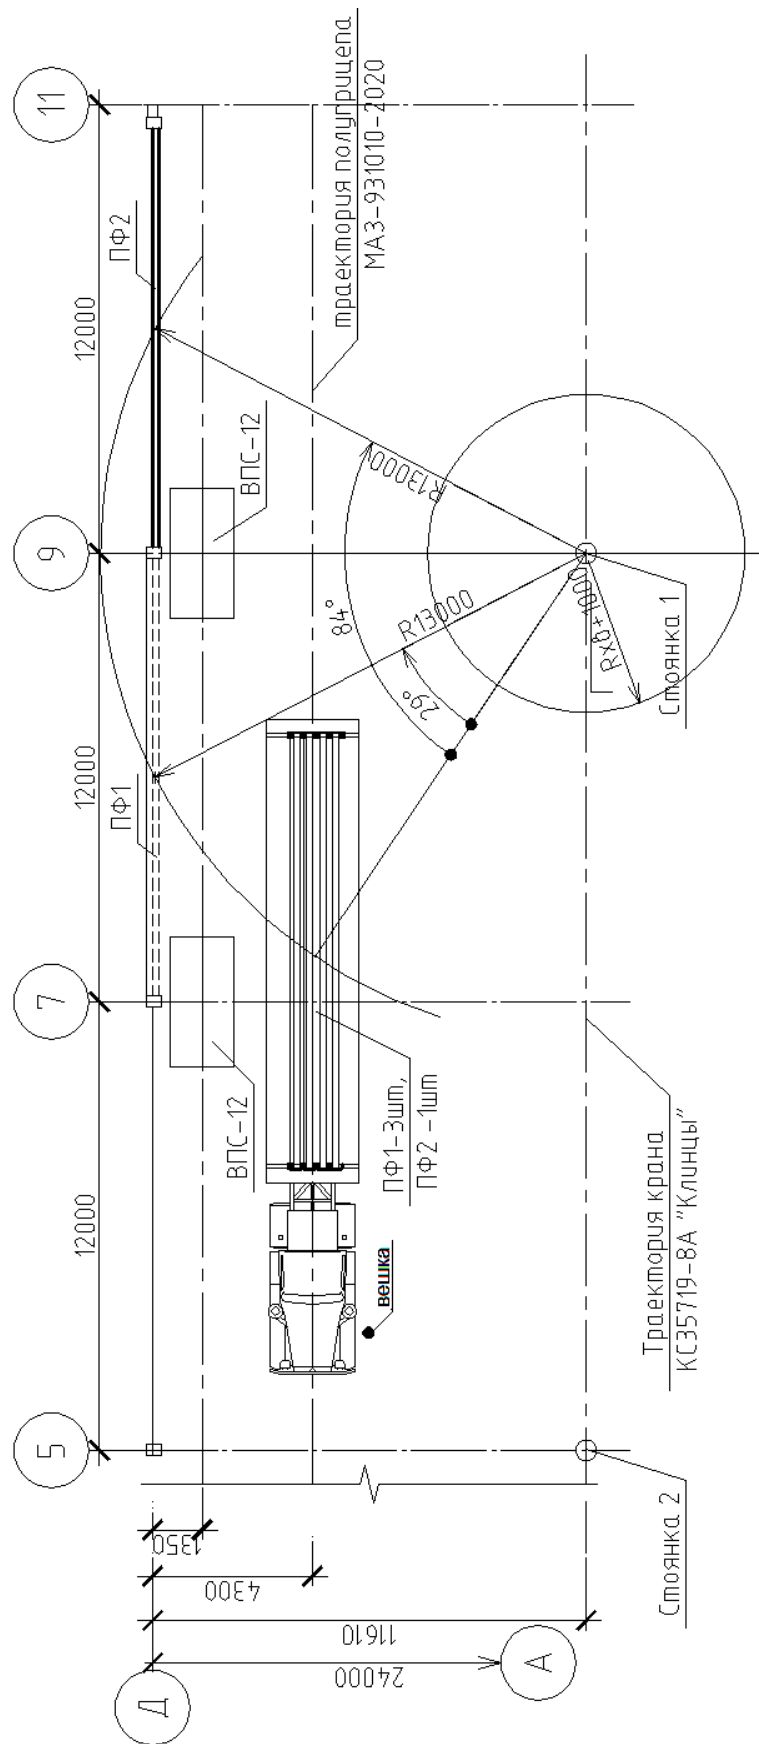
Схема монтажа стальных подстропильных ферм с транспортных средств поворотом стрелы крана
